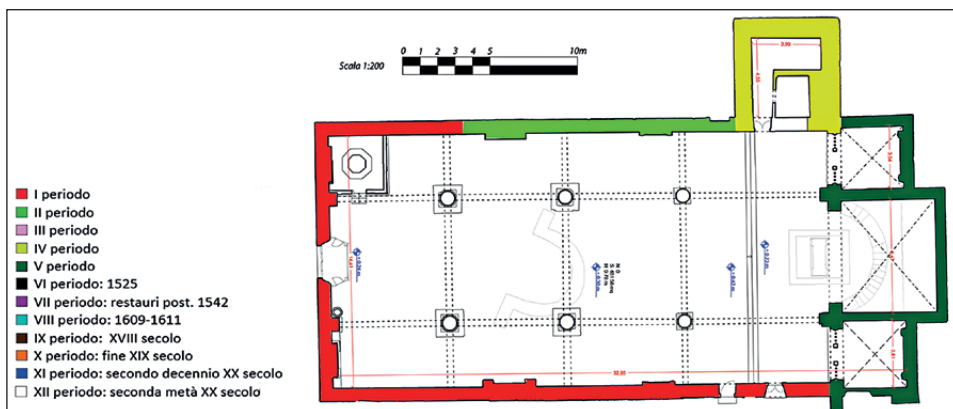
Sezione planimetrica della Pieve di Sant'Agata all'altezza di circa 1,5 m da terra (rilievo e restituzione: M. Repole; coordinamento: A. Arrighetti, G. Minutoli).
